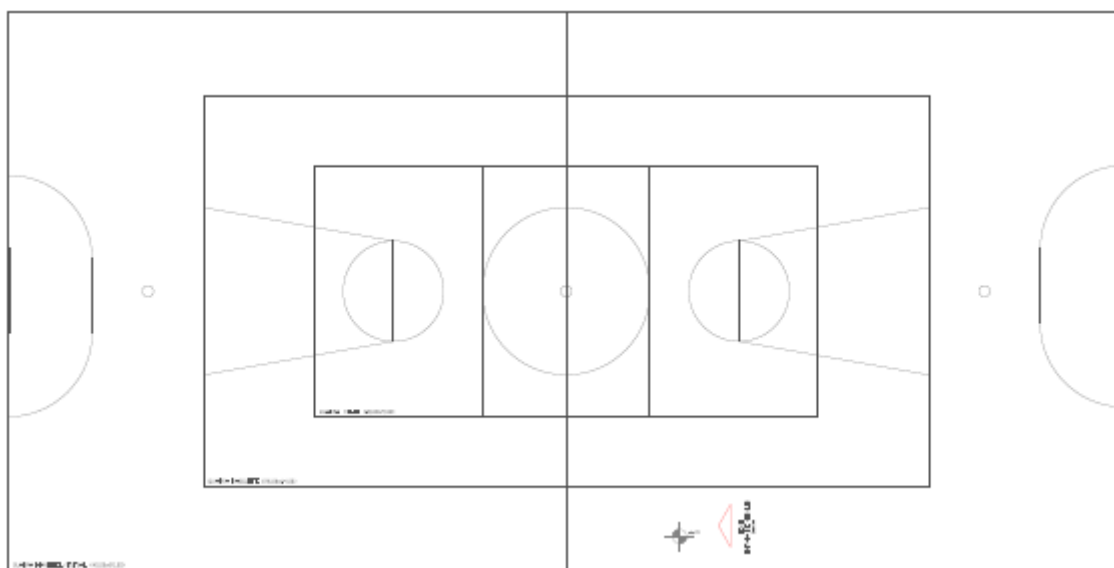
Planta Baixa da Quadra de Futsal em Análise.
